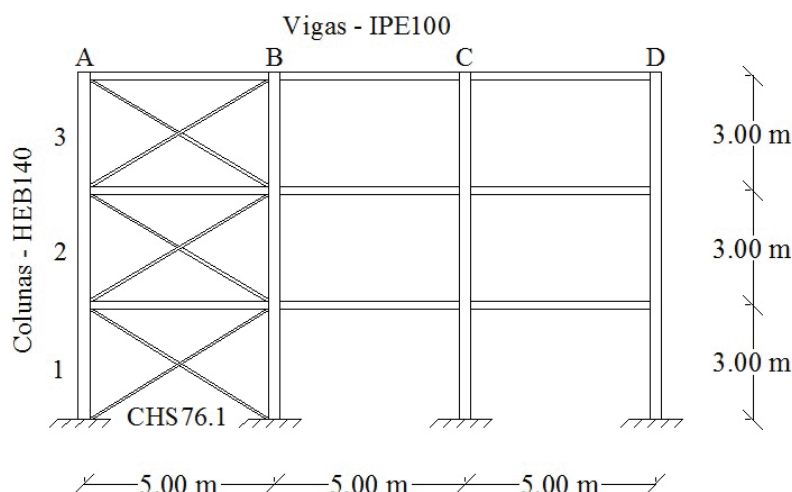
Terceiro caso de estudo - Pórtico parcialmente contraventado
